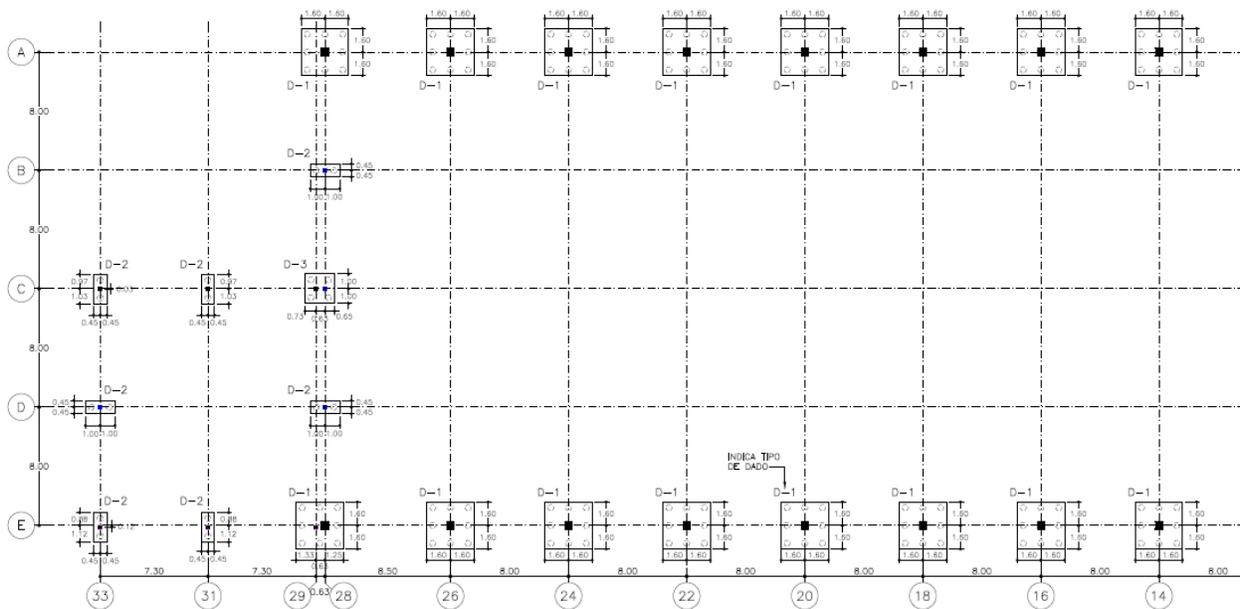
Revisión de planos digitales planta de dados del eje 14-33.
